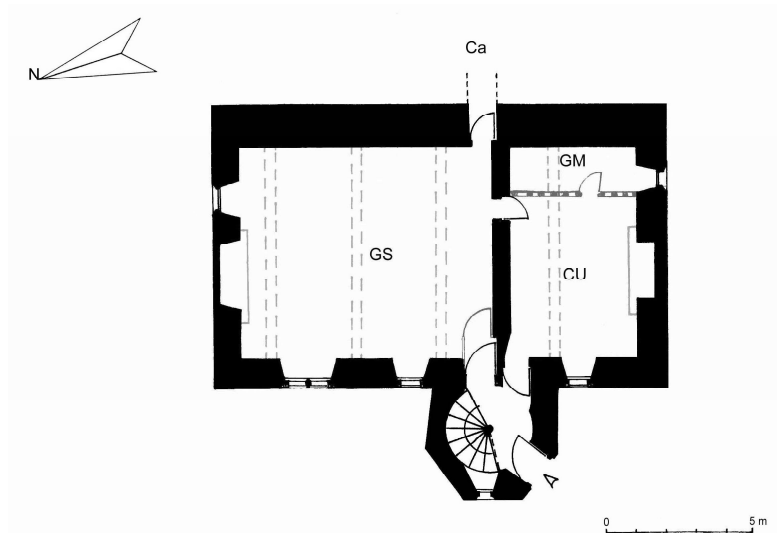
Héronnelles. Plan restitué du rez-de-chaussée vers 1490-1495.
